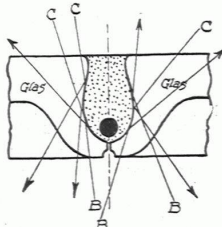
Schnitt durch eine Keppler-Glasbetonrippe, erstes Modell.
